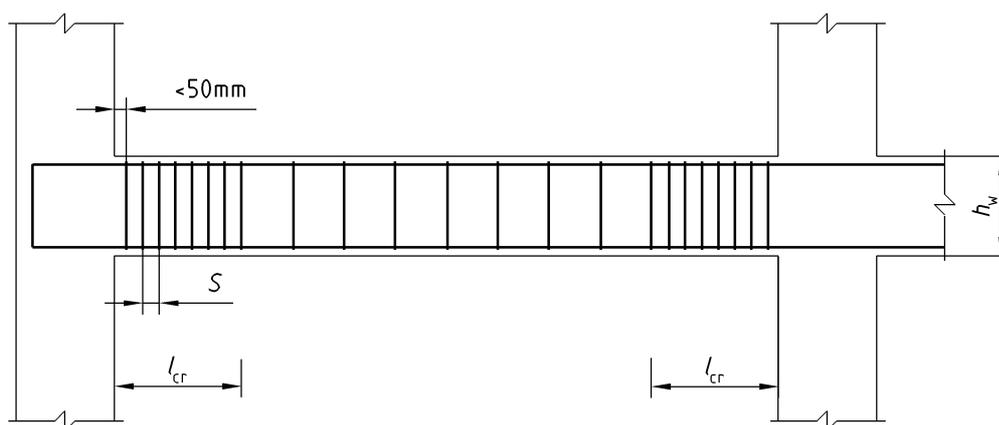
Armatures transversales dans les zones critiques des poutres
